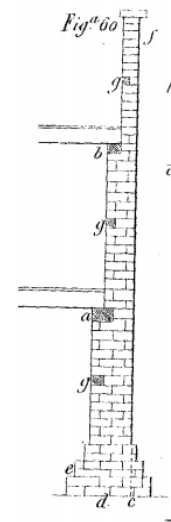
Sección típica de edificio londinense según Millington con carreras de madera embebidas a varias alturas. Cross-section of London's building with bond timber embedded in the masonry according to Millington (21)
